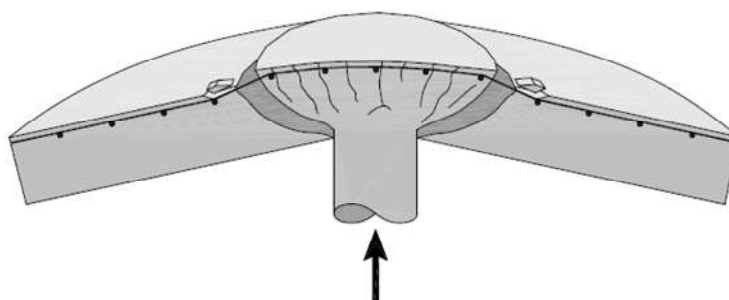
Ruptura por punção da ligação laje-pilar - (TASSINARI, 2011)
